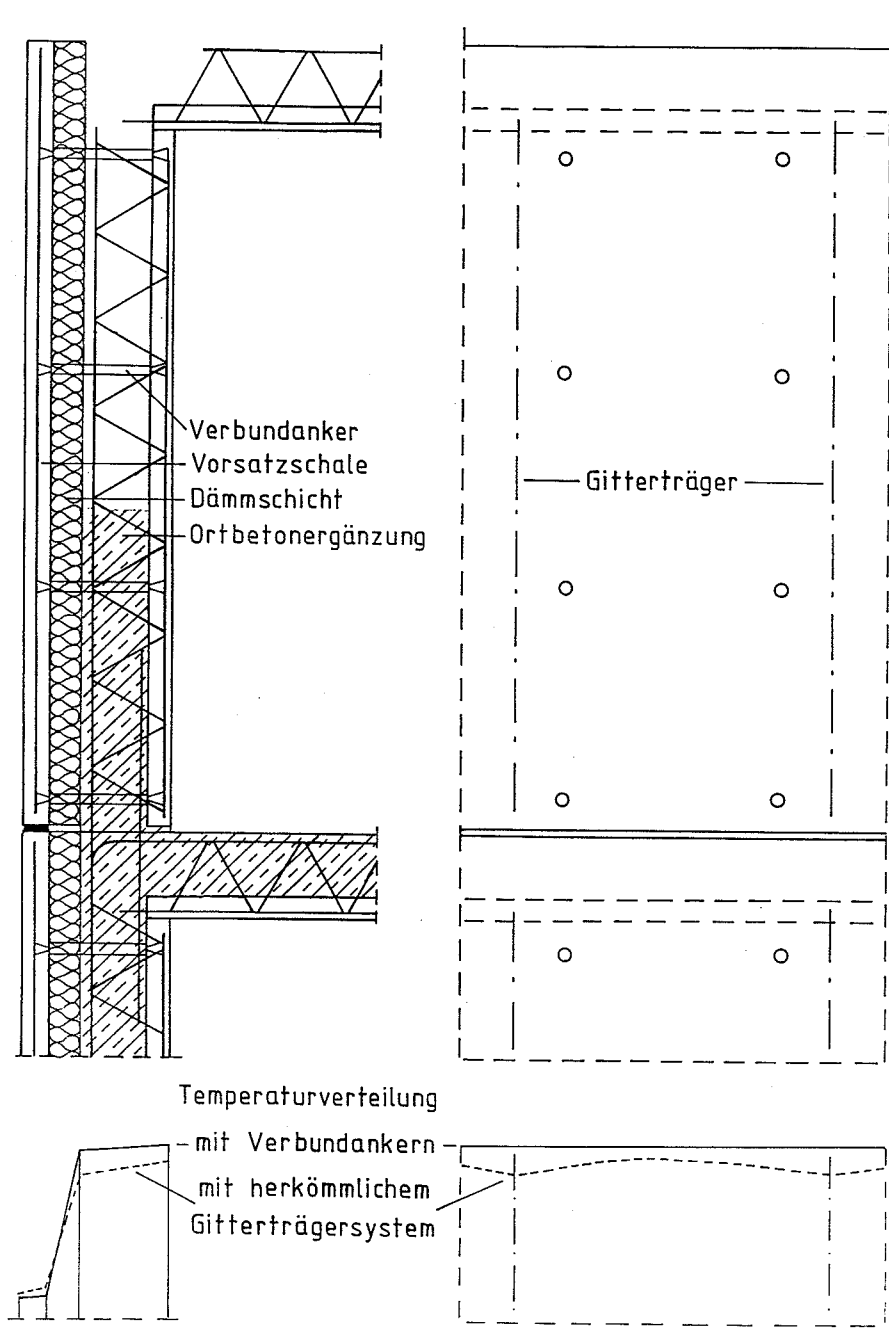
Teilfertigwand mit integrierter Wärmedämmung und Verbundankern nach Bild 4
